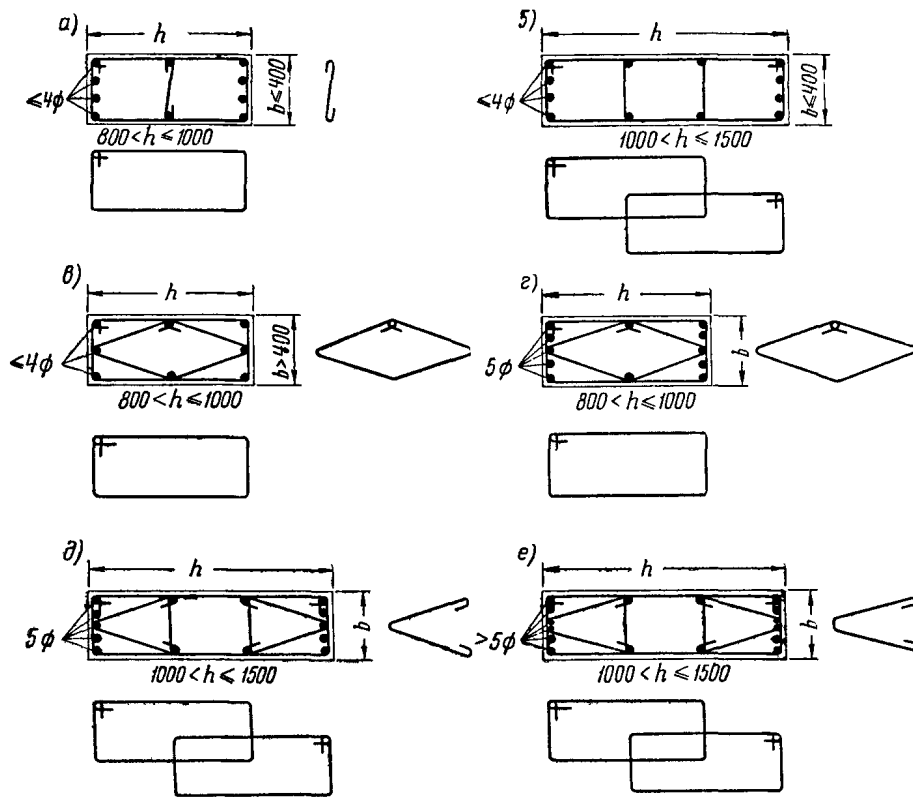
Армирование колонн дополнительными хомутами и конструктивной арматурой
